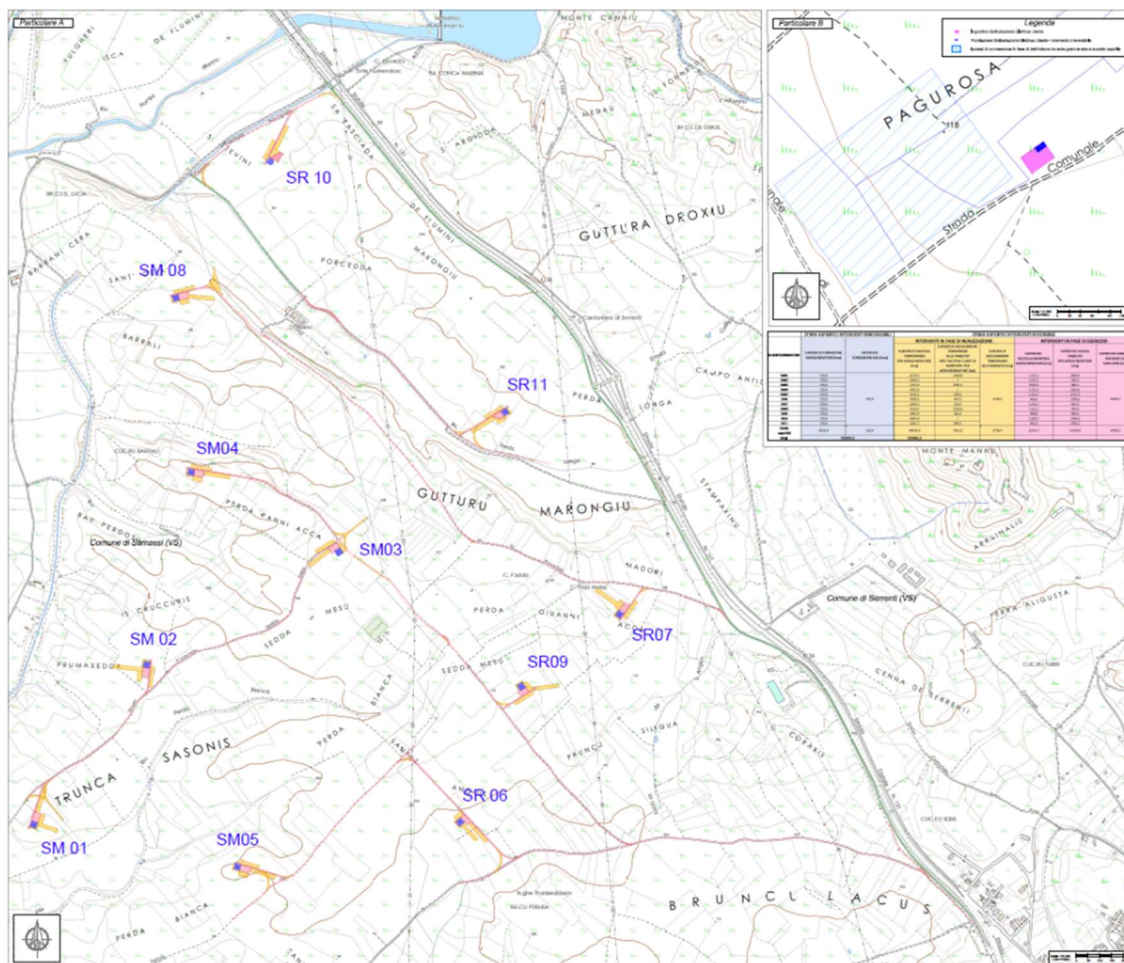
Estratto della planimetria ove sono rappresentate le superfici di suolo occupate dall'impianto
